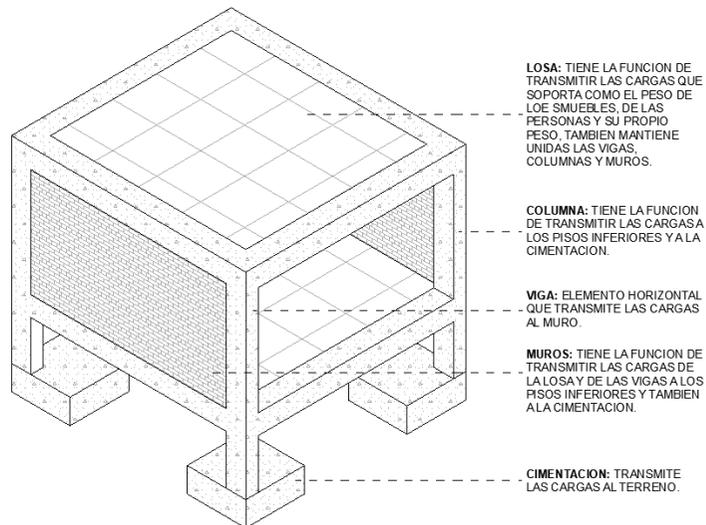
Se muestra el detalle constructivo de sistema de concreto armado.
